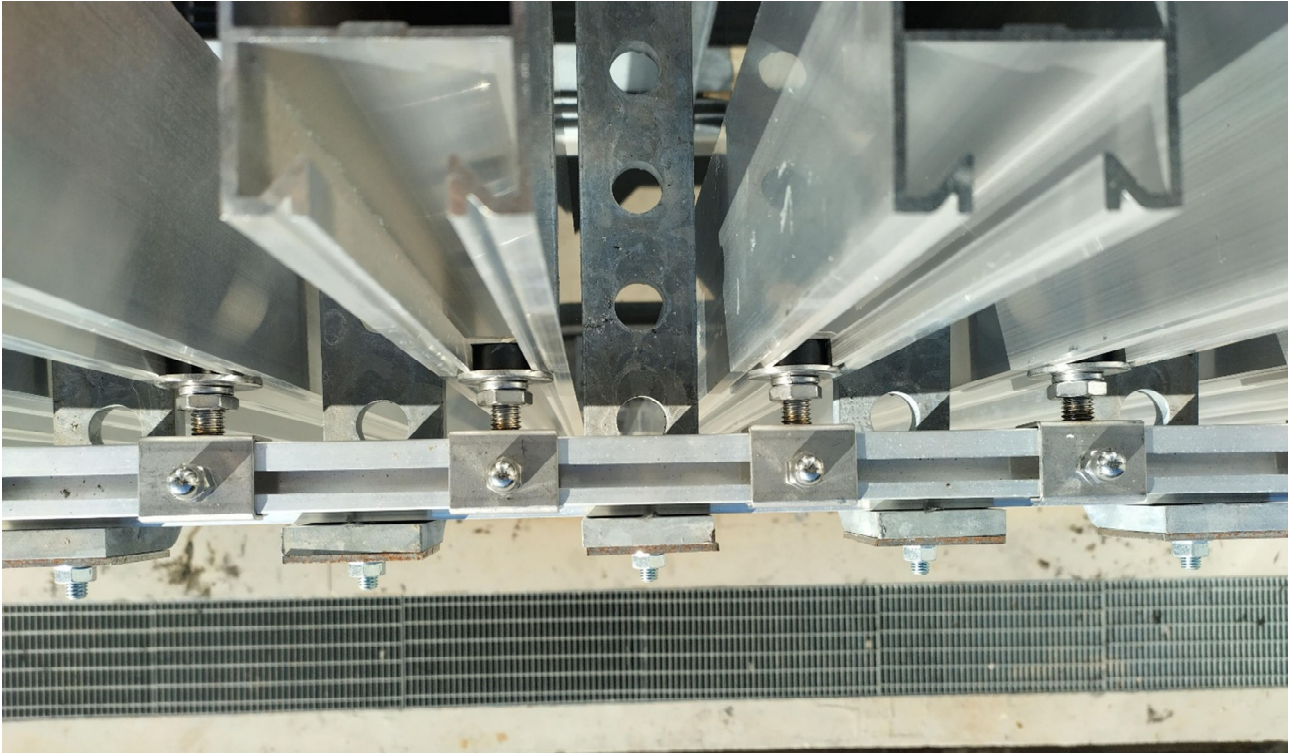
Foto 7. Campione 1126/24/IR: dettaglio del sistema di fissaggio
